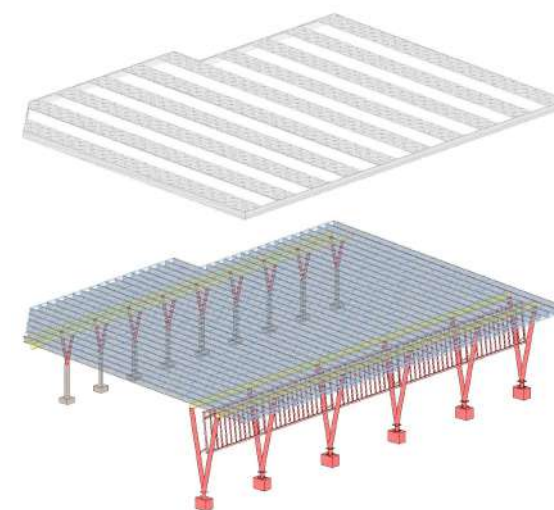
Distribución, sistema estructural – Nivel 3 y cubiertas.
